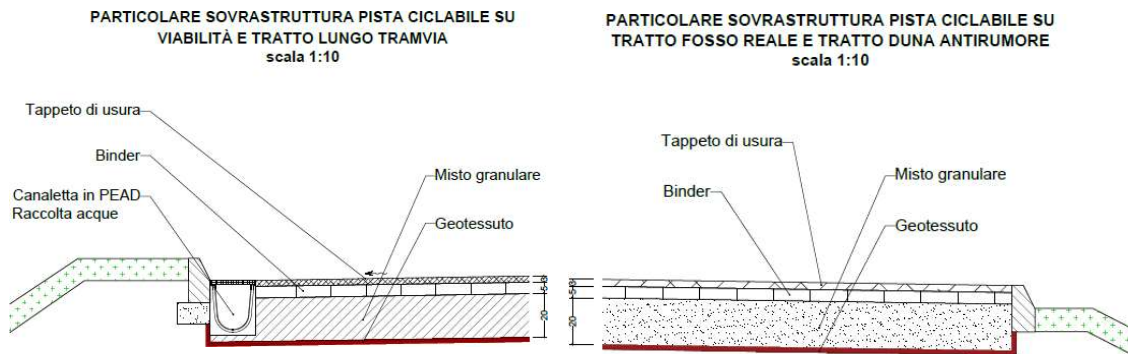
Pacchetto pavimentazione di progetto per la rete ciclabile
